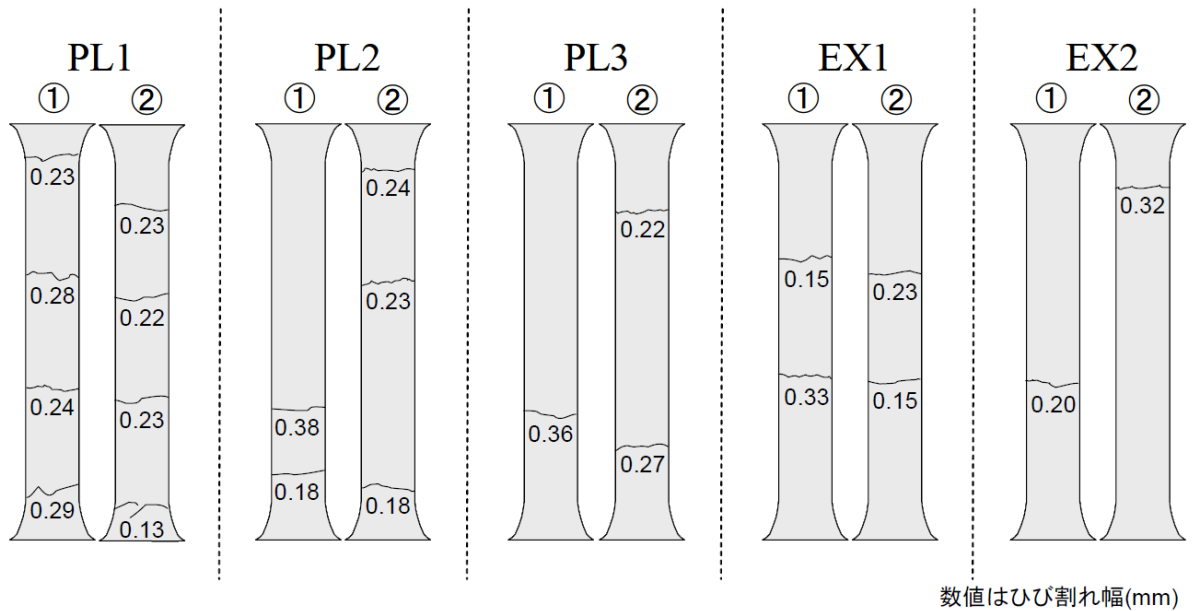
ひび割れ状況（乾燥期間 91 日、幅 0.04mm 以上のひび割れを対象）
